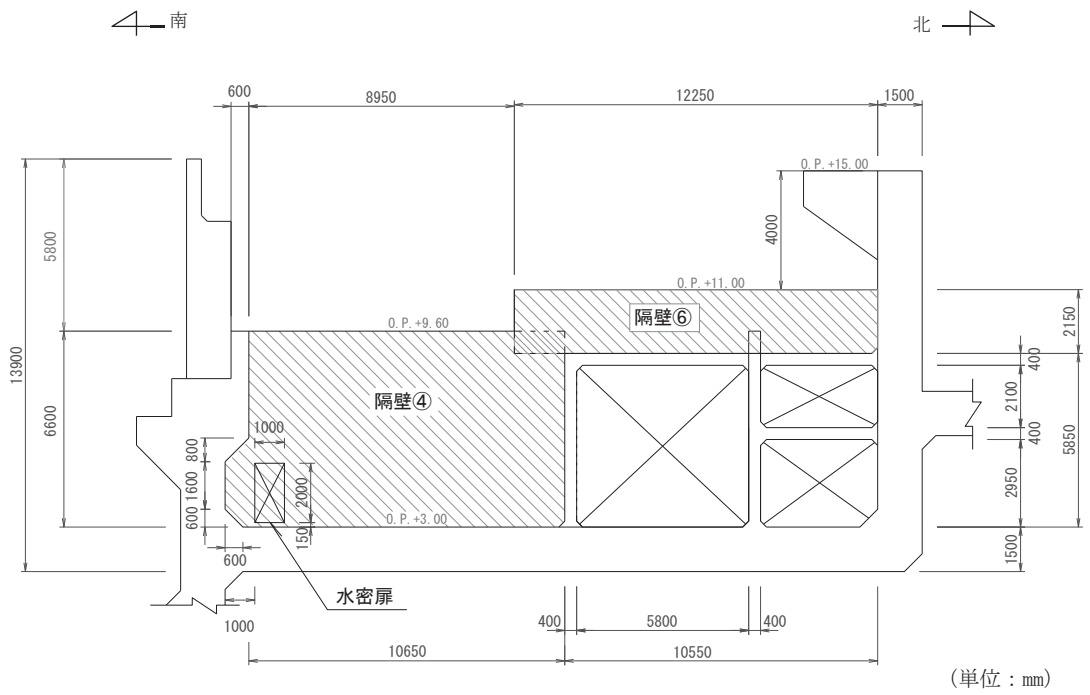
(4) 補機ポンプエリア断面図 (④—④断面)
